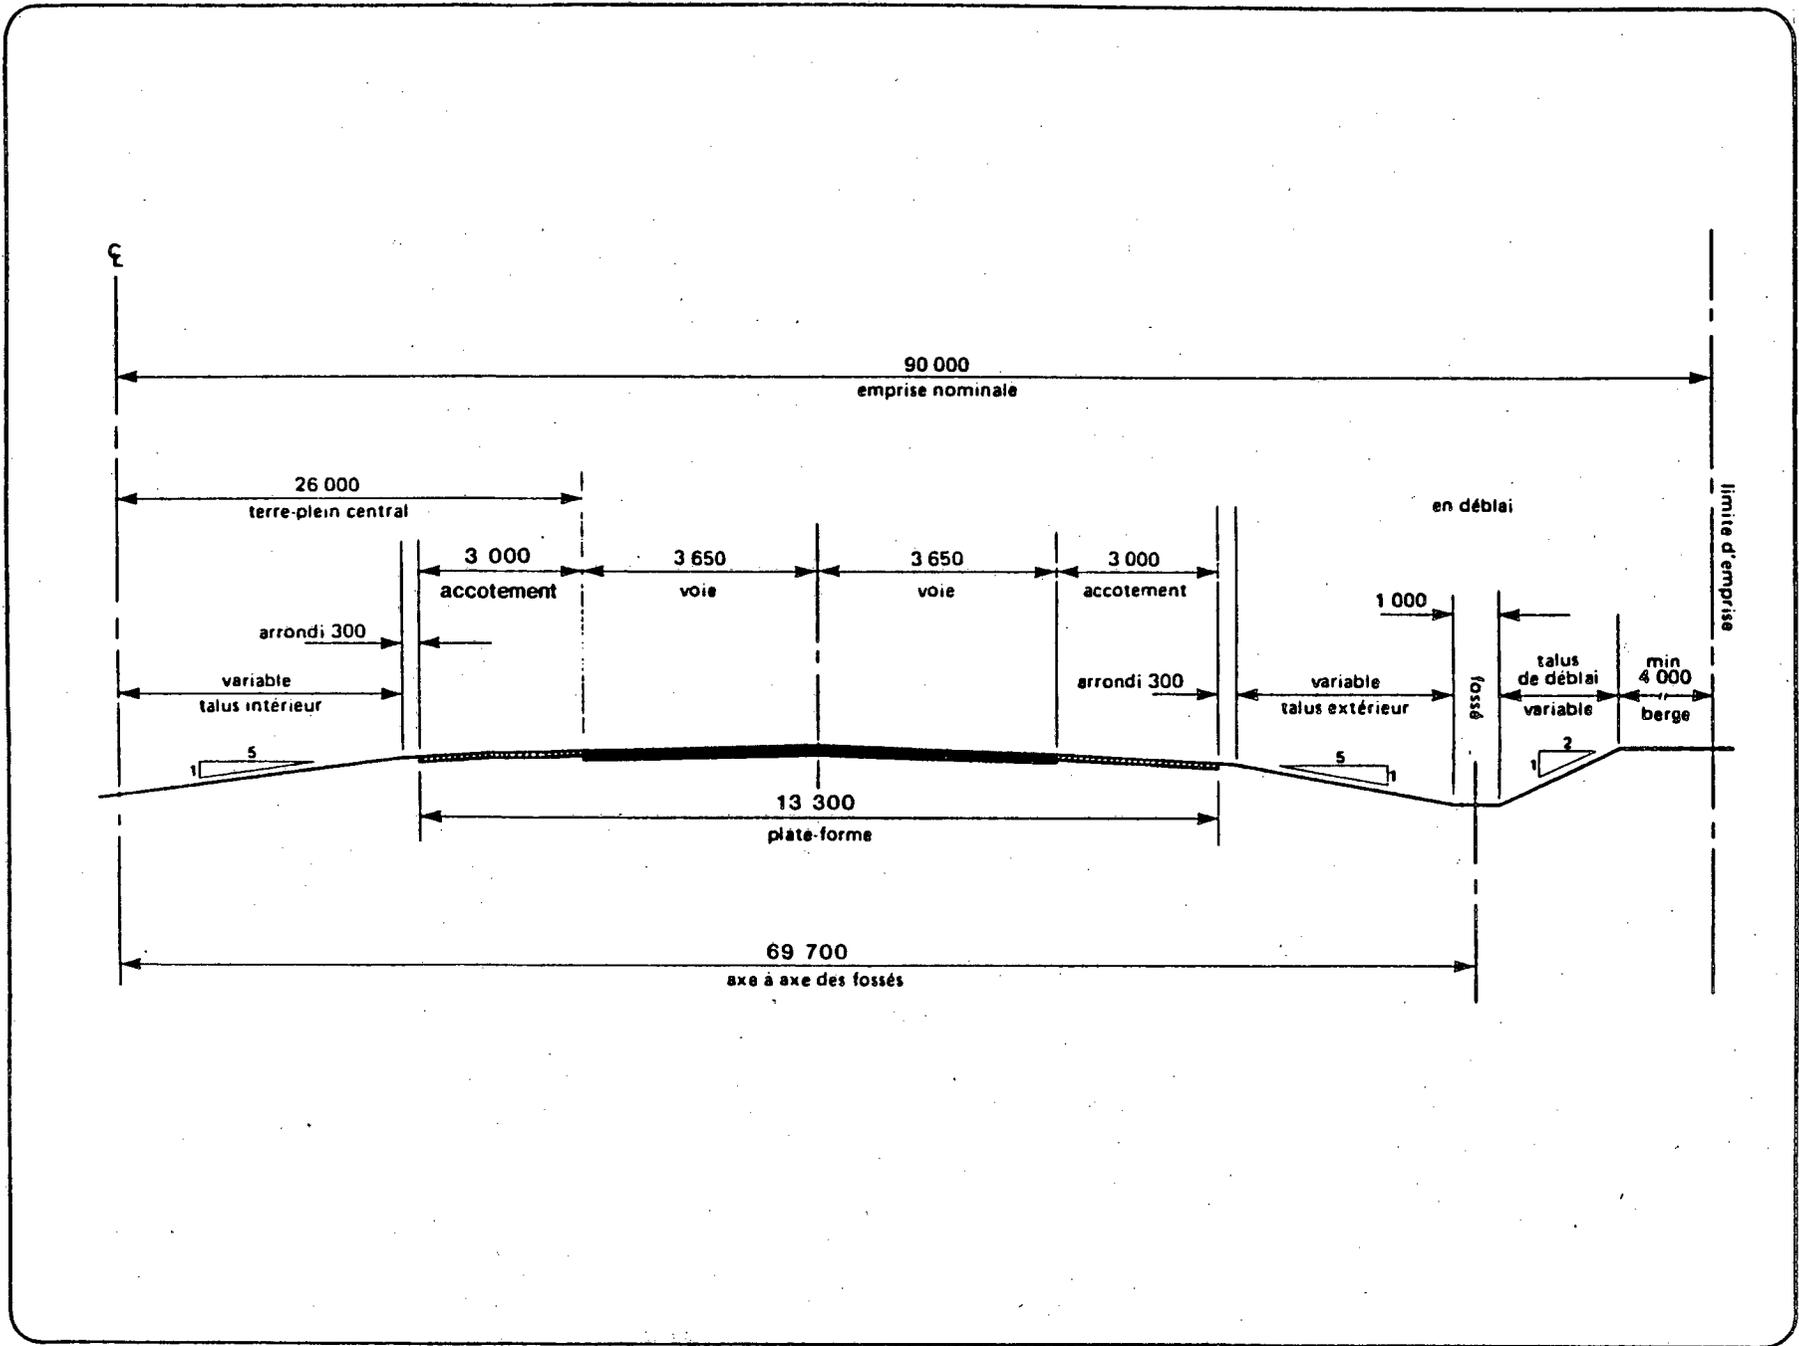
PROFIL EN TRAVERS DE L'AUTOROUTE 10
